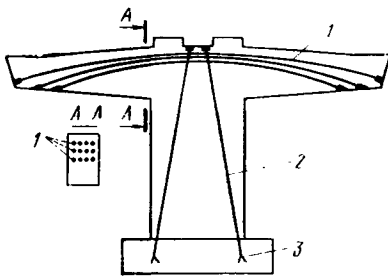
Армирование опоры напрягаемой арматурой:
